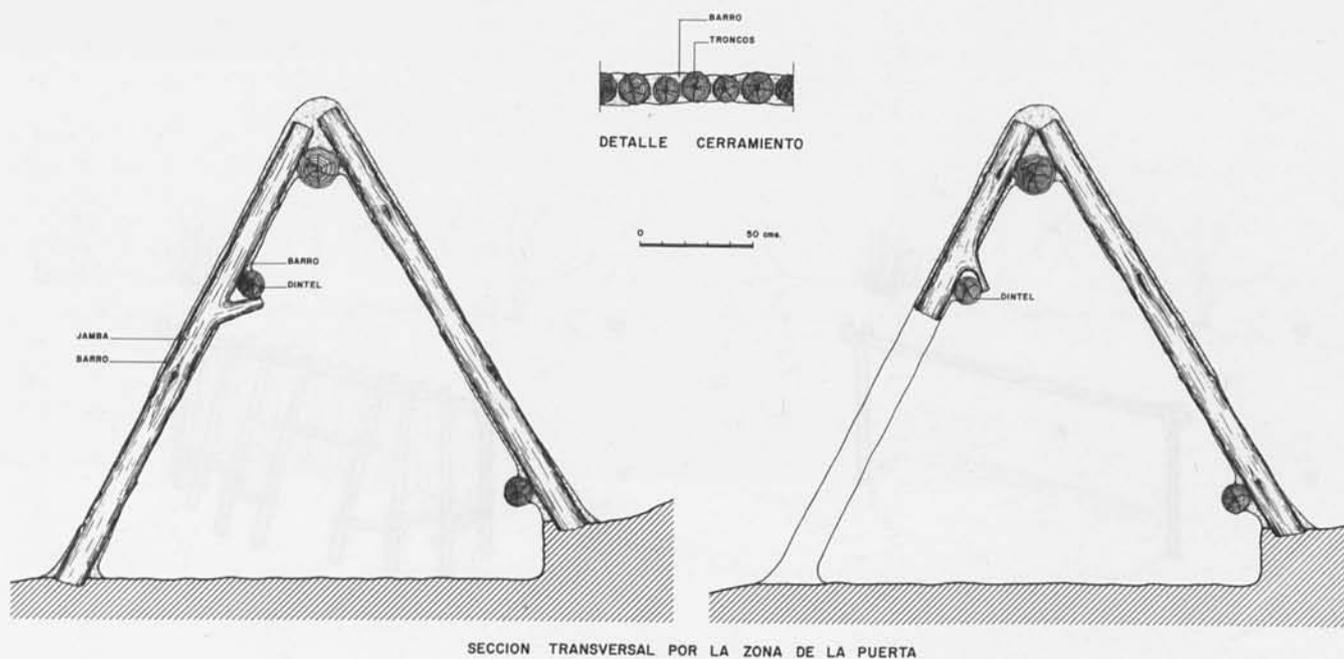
Detalle de la posible solución de la puerta y del cerramiento.
